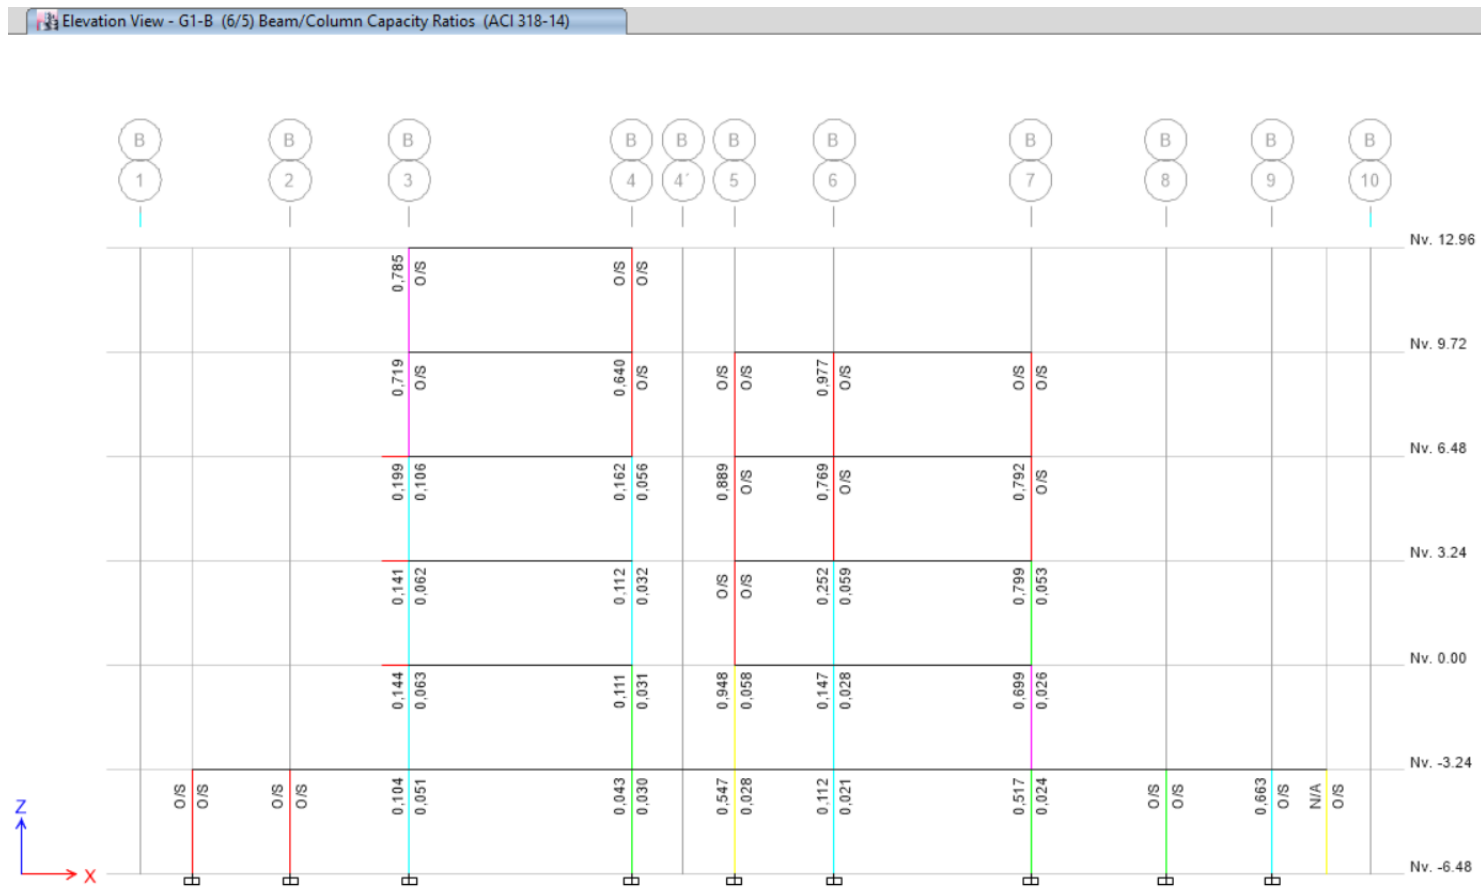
Vista en elevación de factor de capacidad unión viga-columnas, pórtico eje A.
